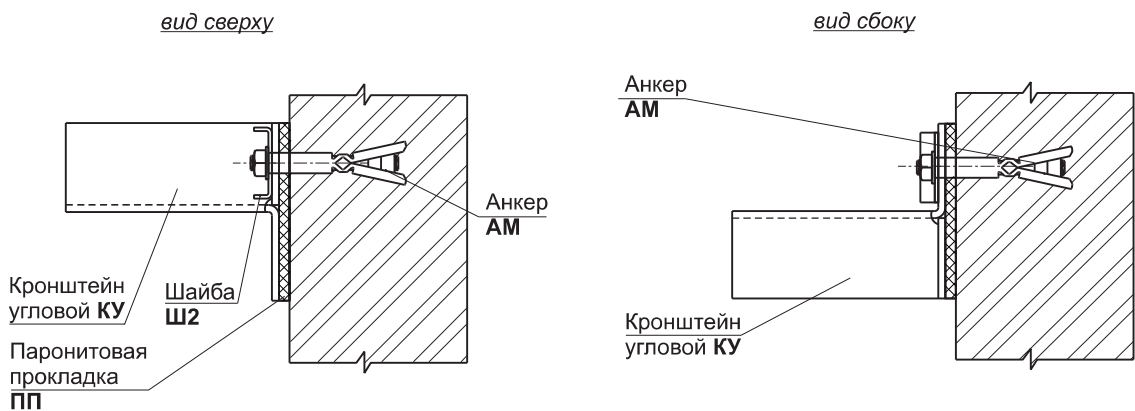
Узел крепления кронштейна КУ к стене одним анкером.
